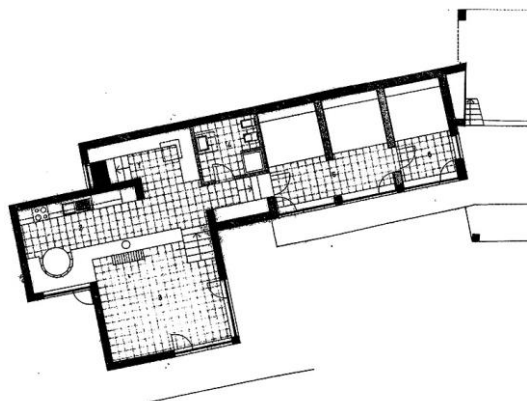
Planta parcial da Casa de Caminha do Arq. Sergio Fernandez (Disponível em: villalcina.blogspot.pt)
